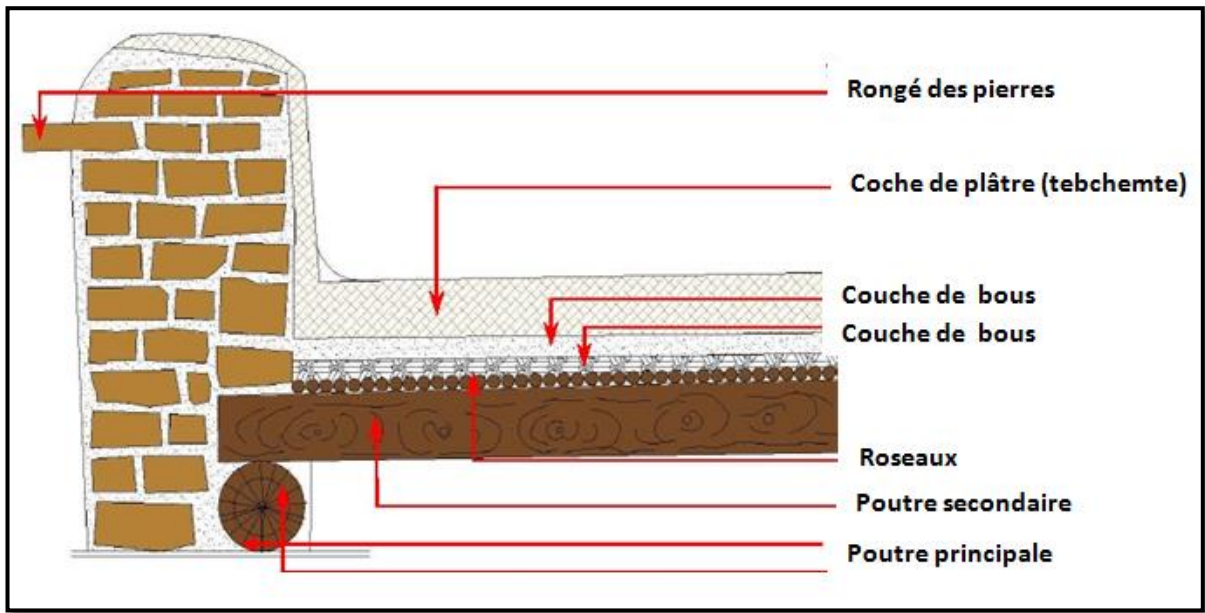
Coupe schématique des planches. (Source par l'auteur)
